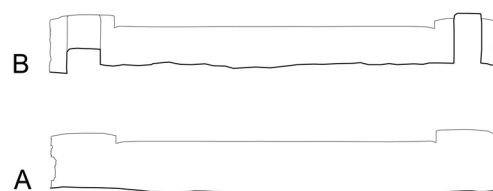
Alzados interior y exterior del murete de cierre del vaso.
